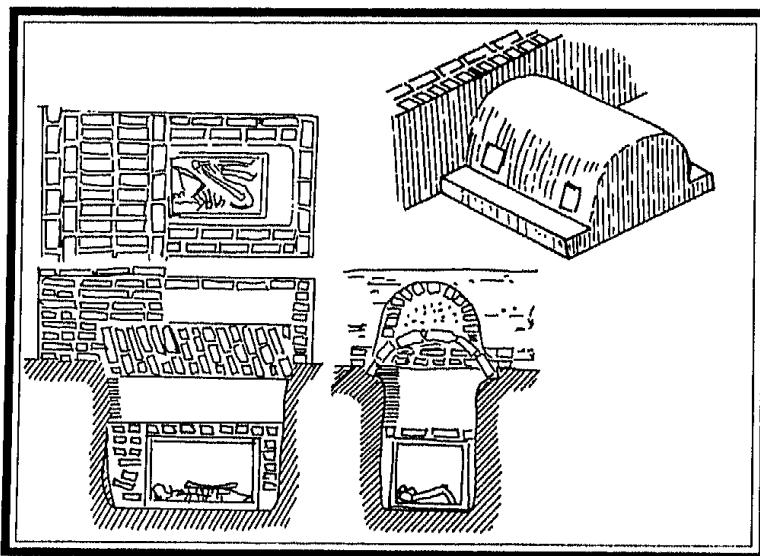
مسقطان أفقى ورأسي لمقبرة في سقارة.
